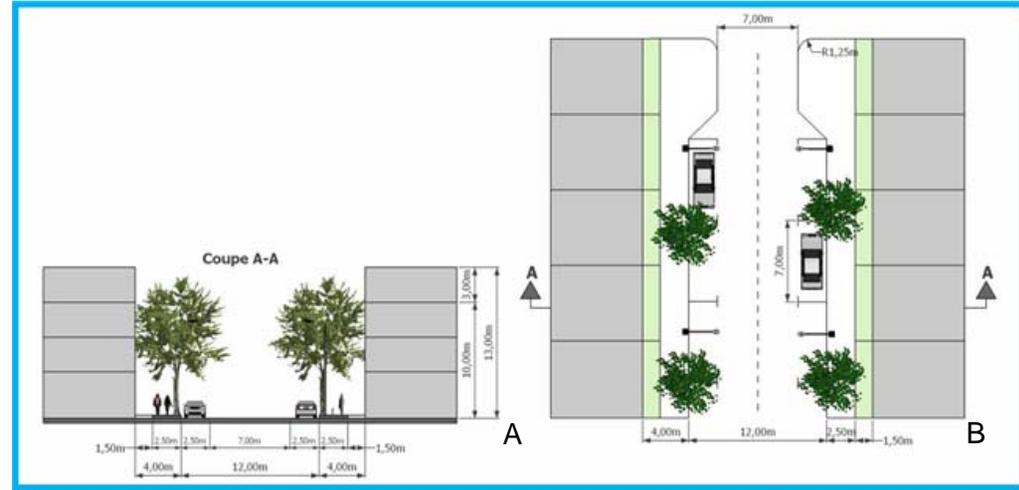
(A) Coupe et (B) plan d'une rue à sens unique
